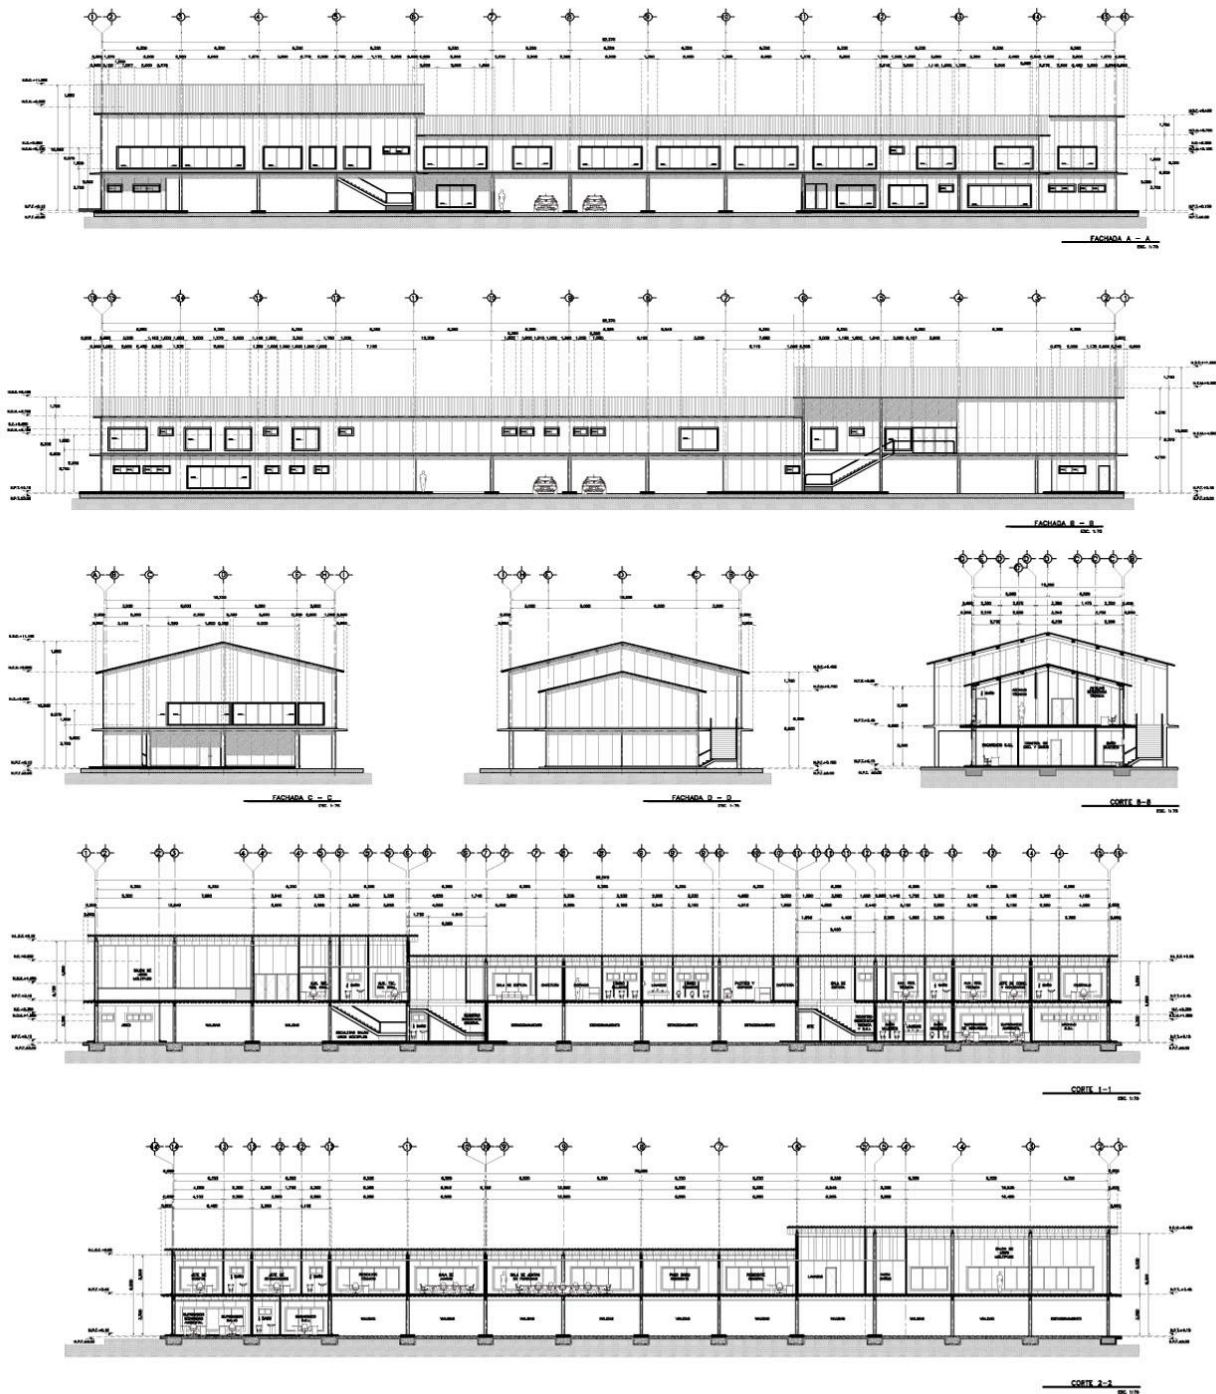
Fachadas y Cortes Residencia Módulo 1.
